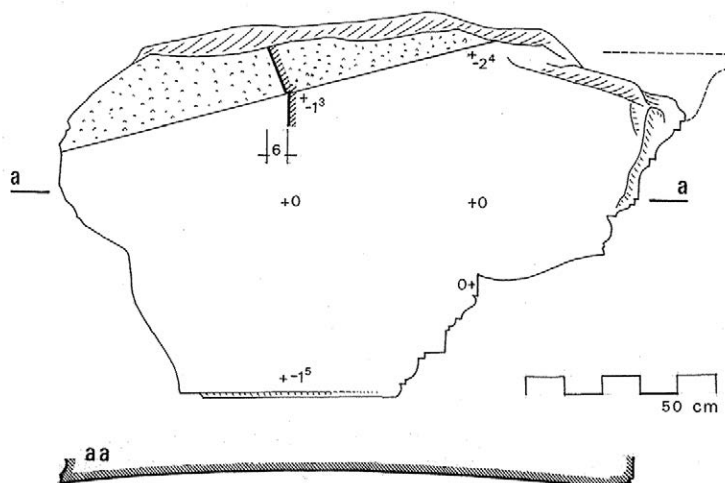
Temple A. Joint vertical du faîtage du fronton et profil en plan concave après sciage (G. Hallier).
